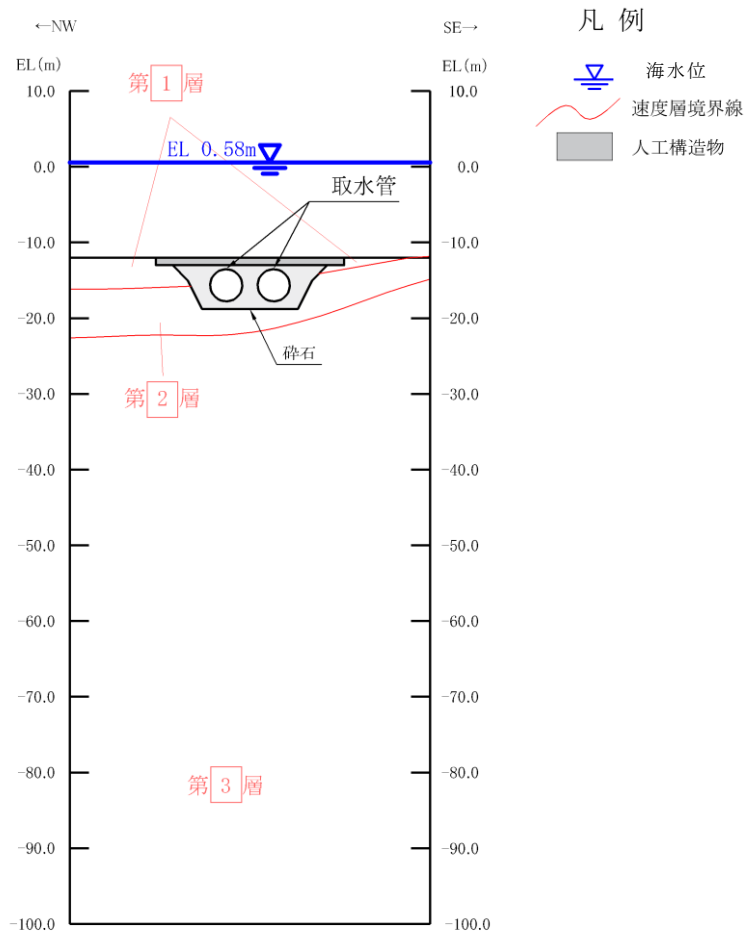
(1) 取水管 地質断面図 (A-A'断面位置)
